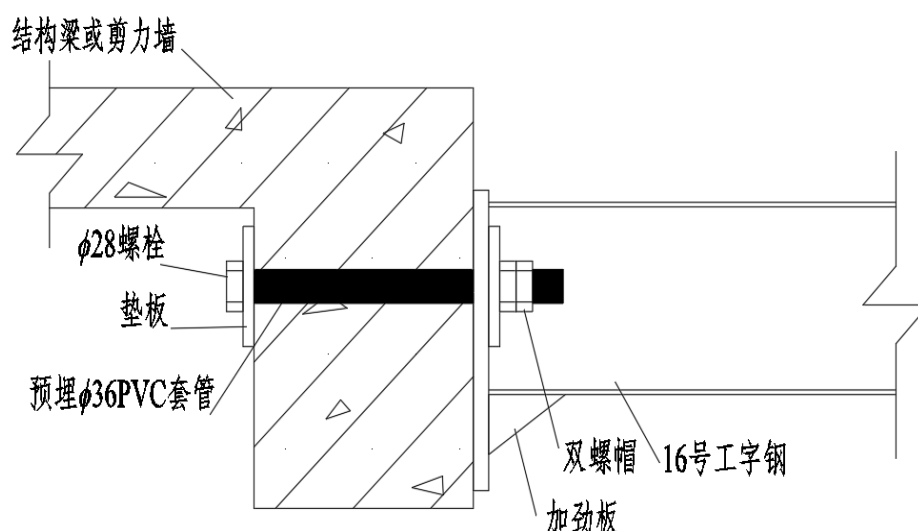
悬挑钢梁与建筑物连接构造
